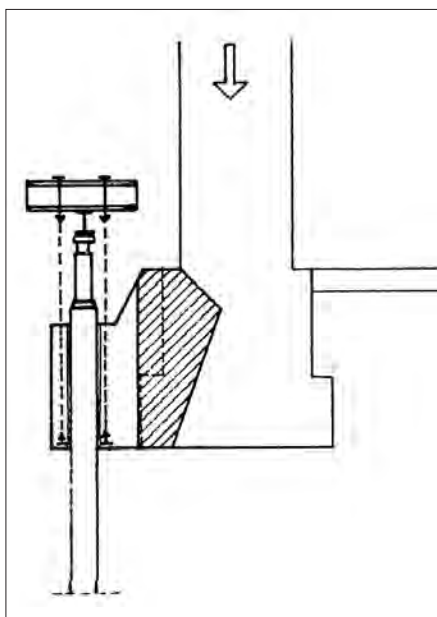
REFUERZO DE BORDE PARA TRANSMITIR CARGAS VERTICALES.
